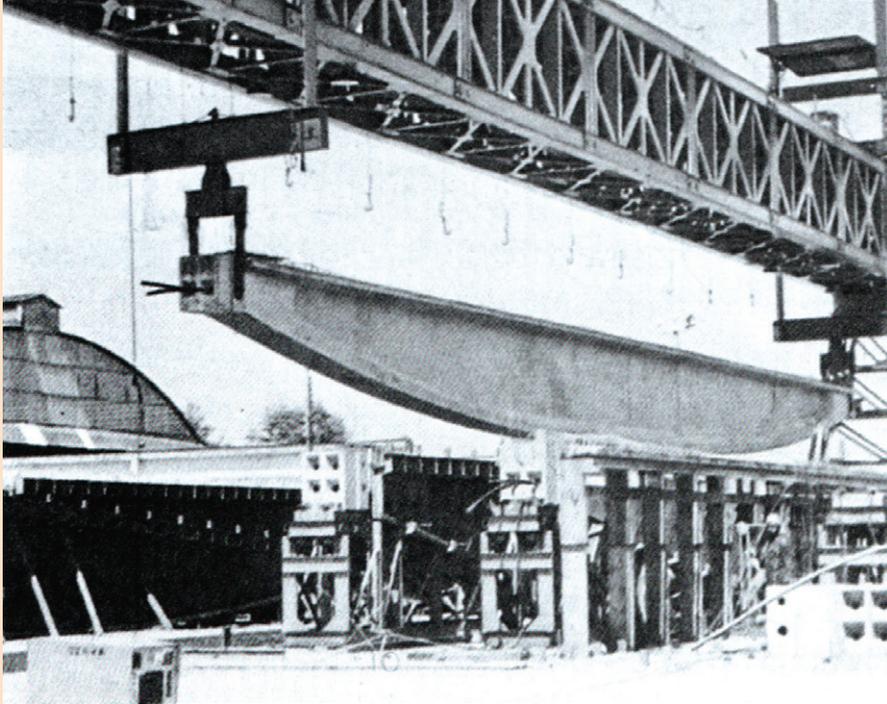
MOVIMENTAÇÃO DE UMA VIGA “BARRIGA DE PEIXE” NO CANTEIRO DE PRÉ-FABRICAÇÃO [10]
